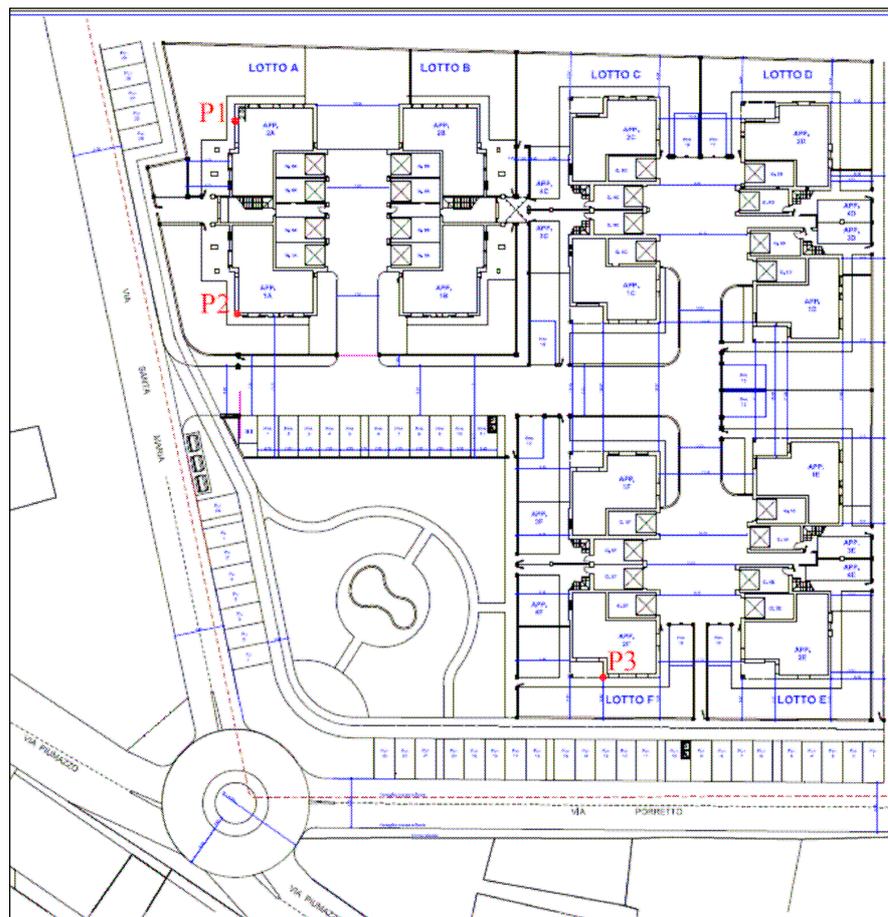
Stralcio planimetria di progetto e punti di misura.
